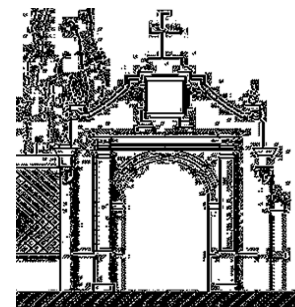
Alzado de acceso sin cotas, dibujado sobre fotografía monoscópica. Fuente: Del Autor.
